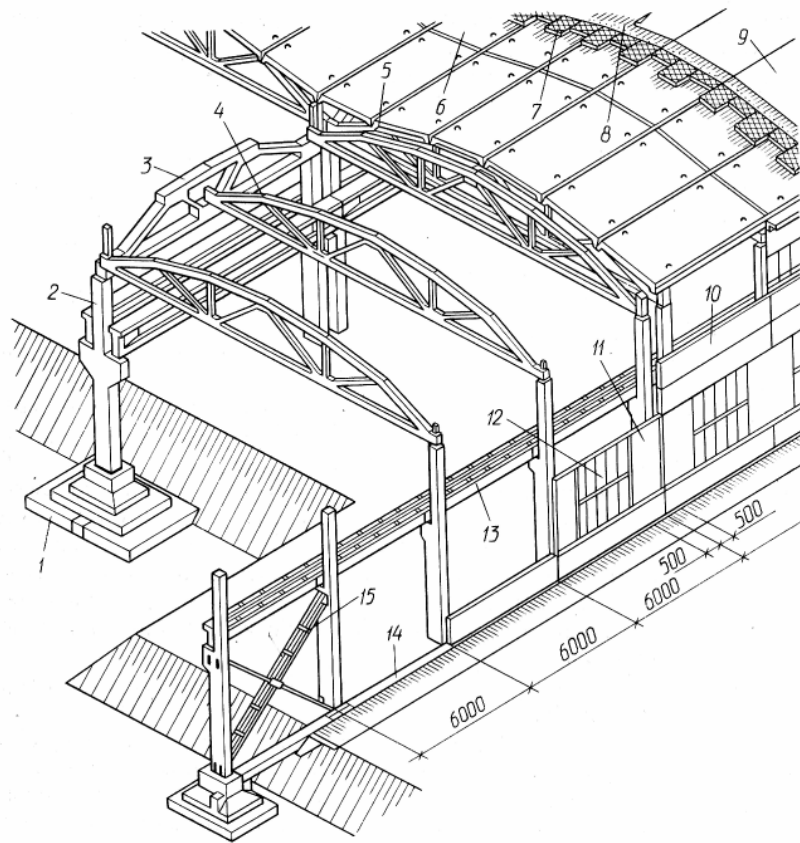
Залізобетонний каркас з кроквяними фермами:
